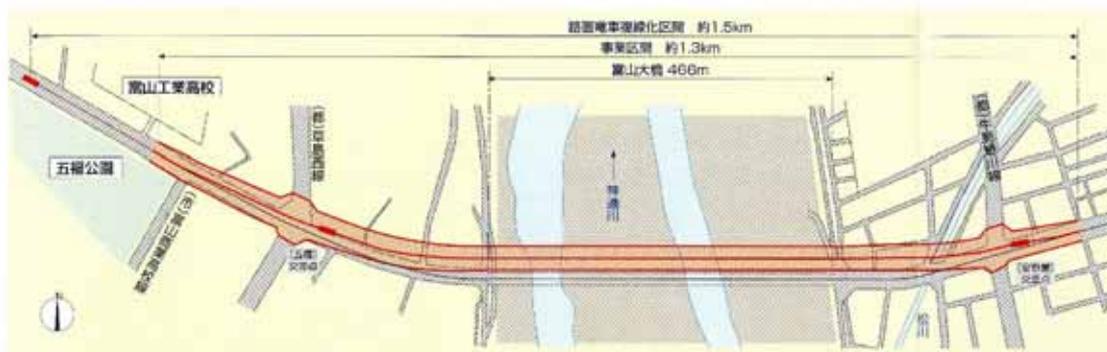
富山大橋の架け替え計画平面図と複線化イメージ
